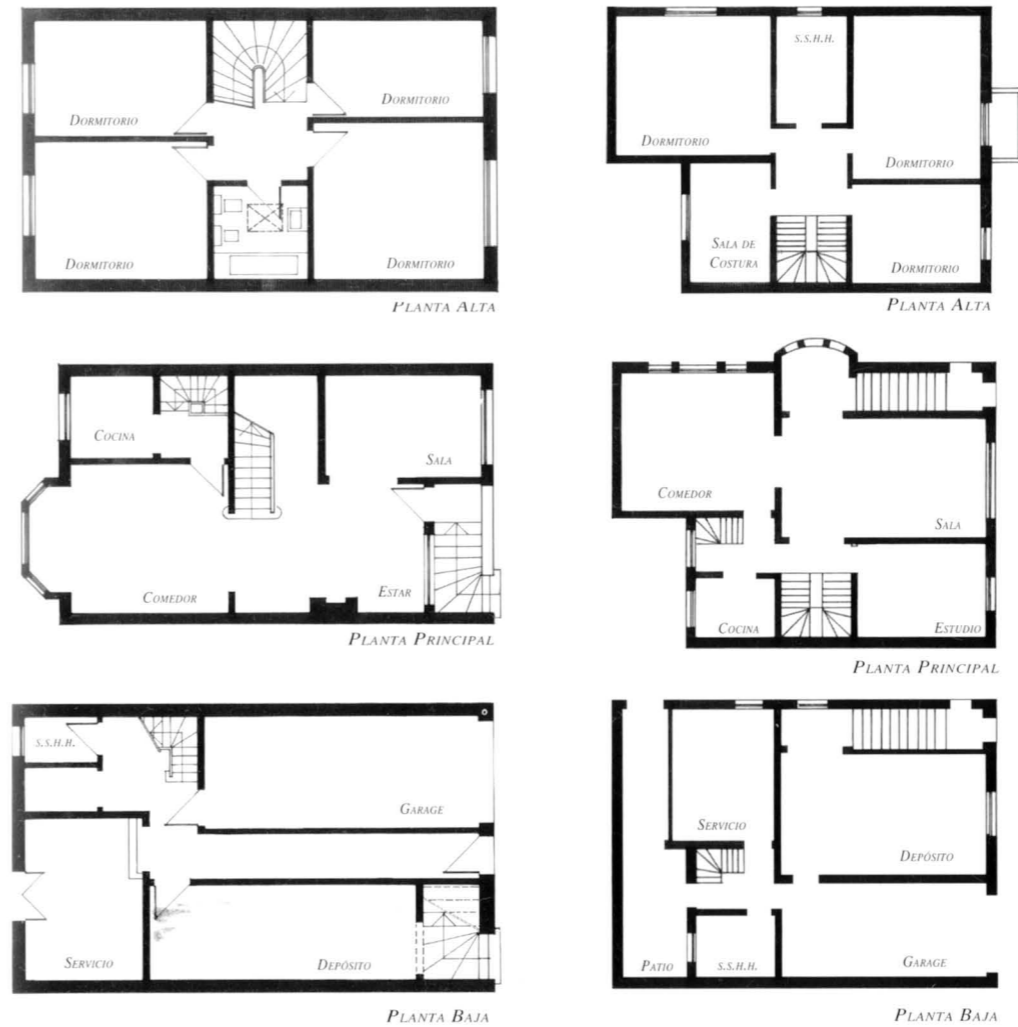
"Plano Tipo" Para construir en serie viviendas de 3 niveles; frente entre 6 y 7 mts. -Interpretación de las autoras-
